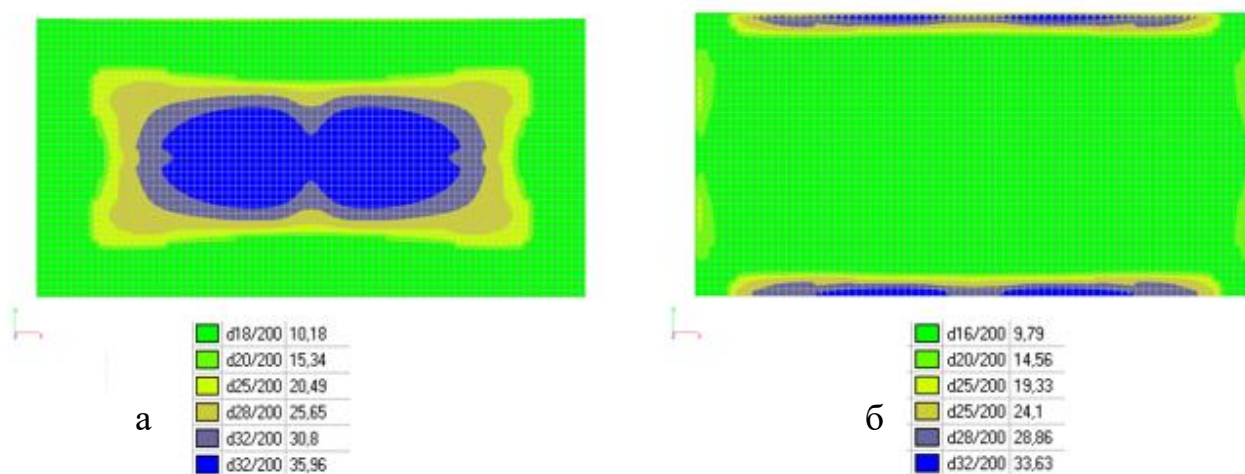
Армирование плиты покрытия в поперечном направлении при нагрузке от собственного веса ($\text{см}^2/\text{м}$)
